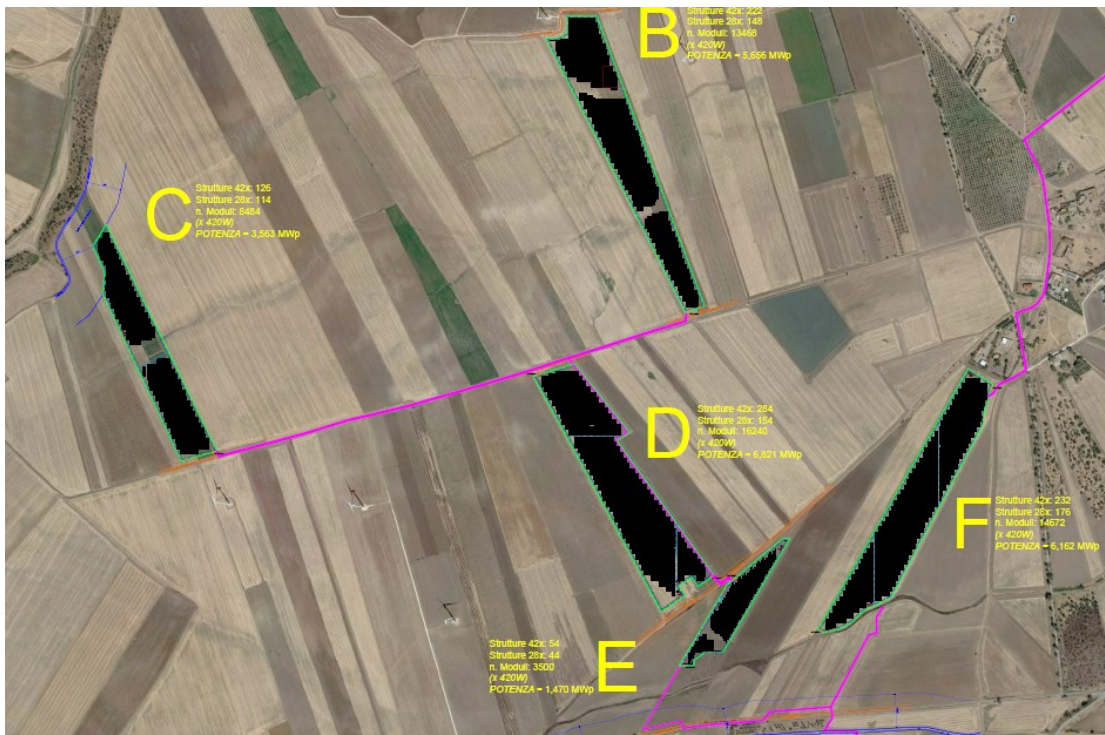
Layout di impianto dell’Area B-C-D-E e F
